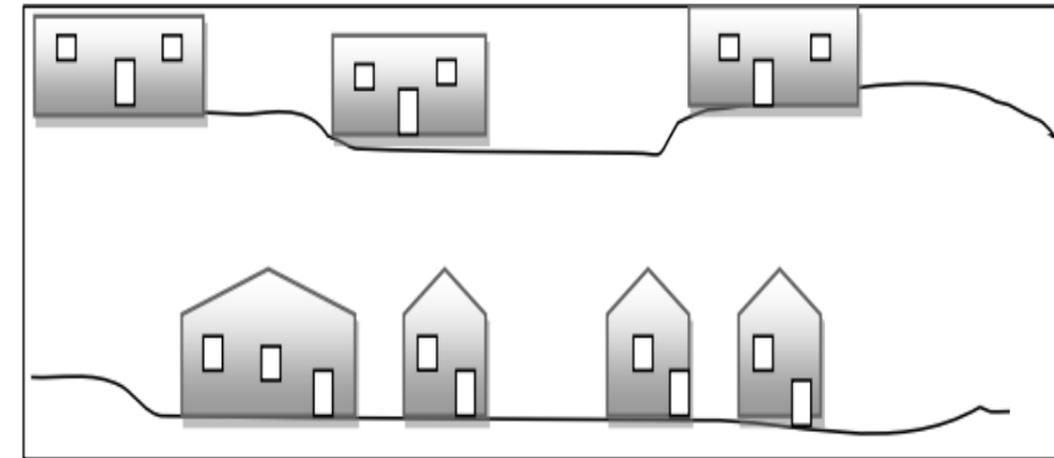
8: Exemple d'une façade à Ain-Ouarka (Chellali Boutheina, Rafai Ikram)
